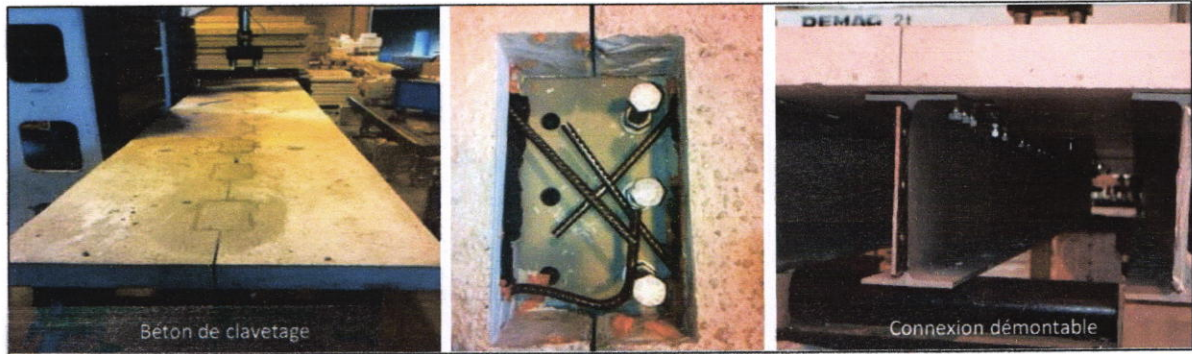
plancher mixte (DEMODELOR) La conjugaison des performances mécaniques de l'acier et du béton ; source : www.ademe.fr.
